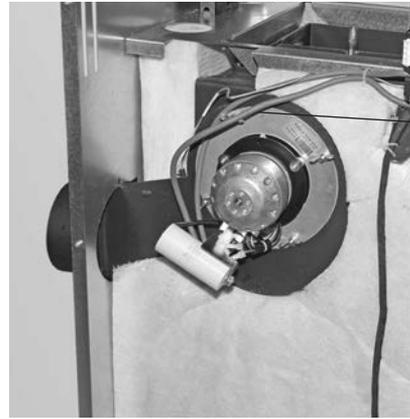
Abgasgebläse um 90° verdreht wieder anschrauben
